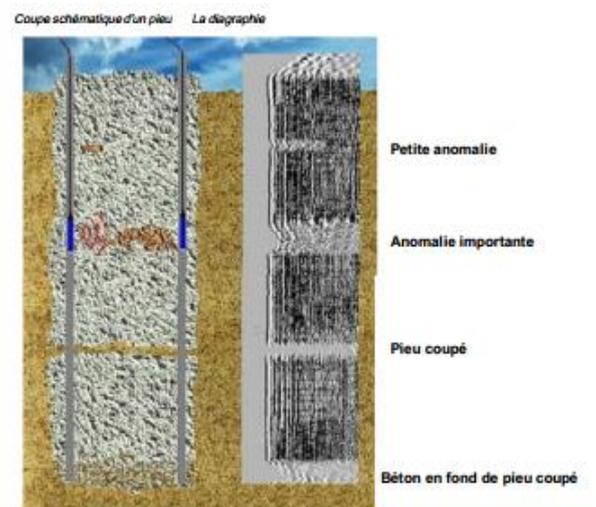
Coupe schématique d'un pieux mal réalisé.
